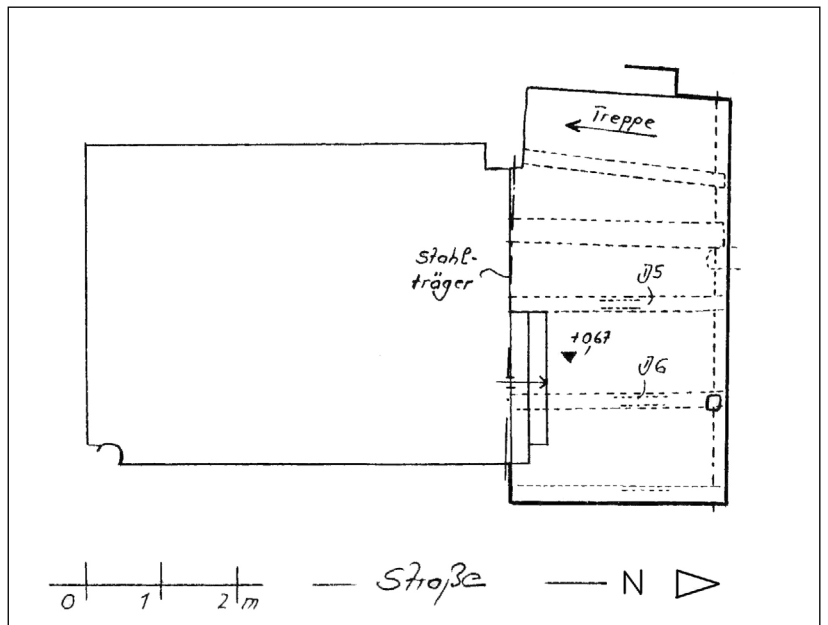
Auf dem Graben 44/46, Grundriss Keller, um 1470.
